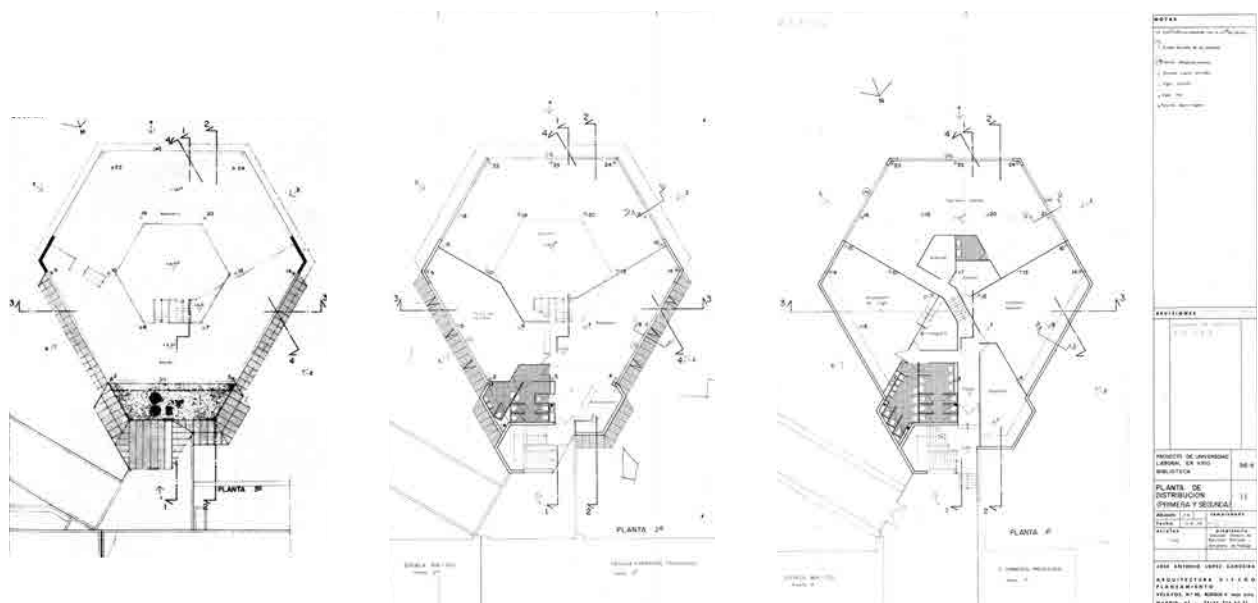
, Fig. 62 y Fig. 63 Biblioteca. Planta tercera (izquierda), planta segunda (centro) y planta primera (derecha).
